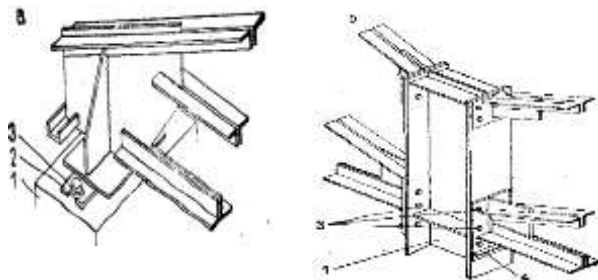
Спряження кроквяних ферм з колонами: а – шарнірне; б – жорстке (рамне); 1 – колона; 2 – опорний лист; 3 – болт; 4 – опорний столик.
